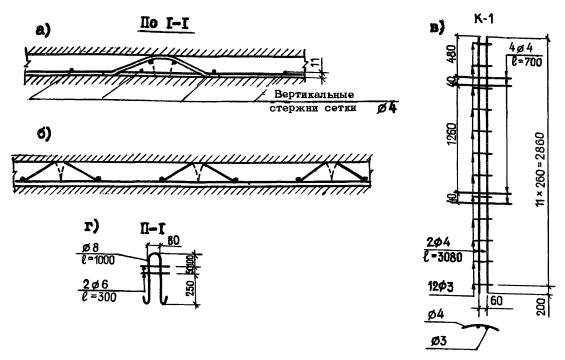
Пример армирования панелей и фиксации арматурной сетки:
